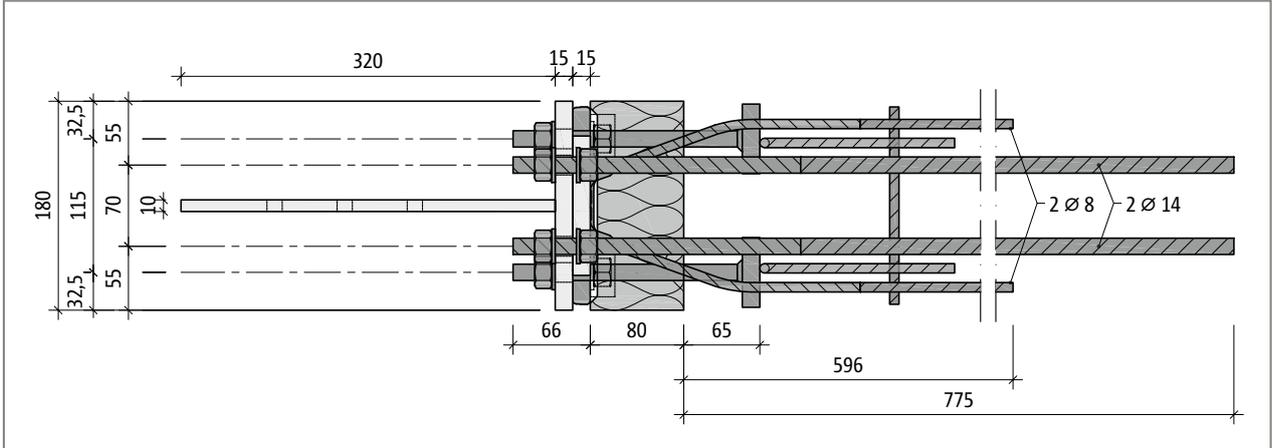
Schöck Isokorb® T Typ SK mit Stahlschwert: Grundriss
